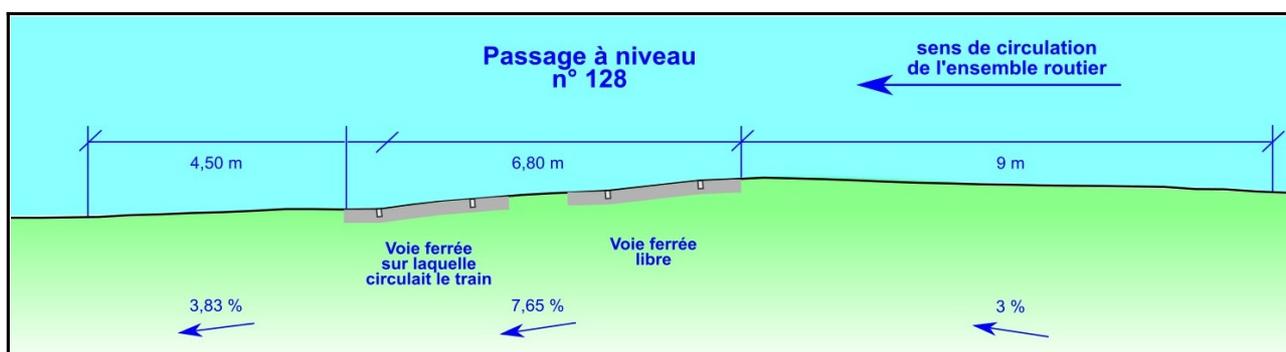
Le profil en long de la voie routière au droit du passage à niveau n° 128
